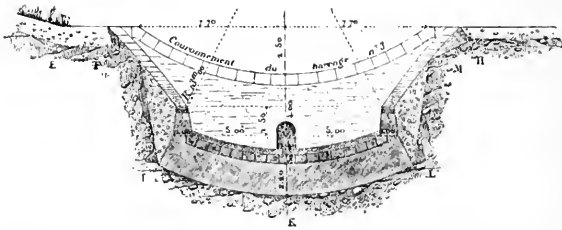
Coupe du Radier et des murs en aile suivant le profil en travers n° 1.
